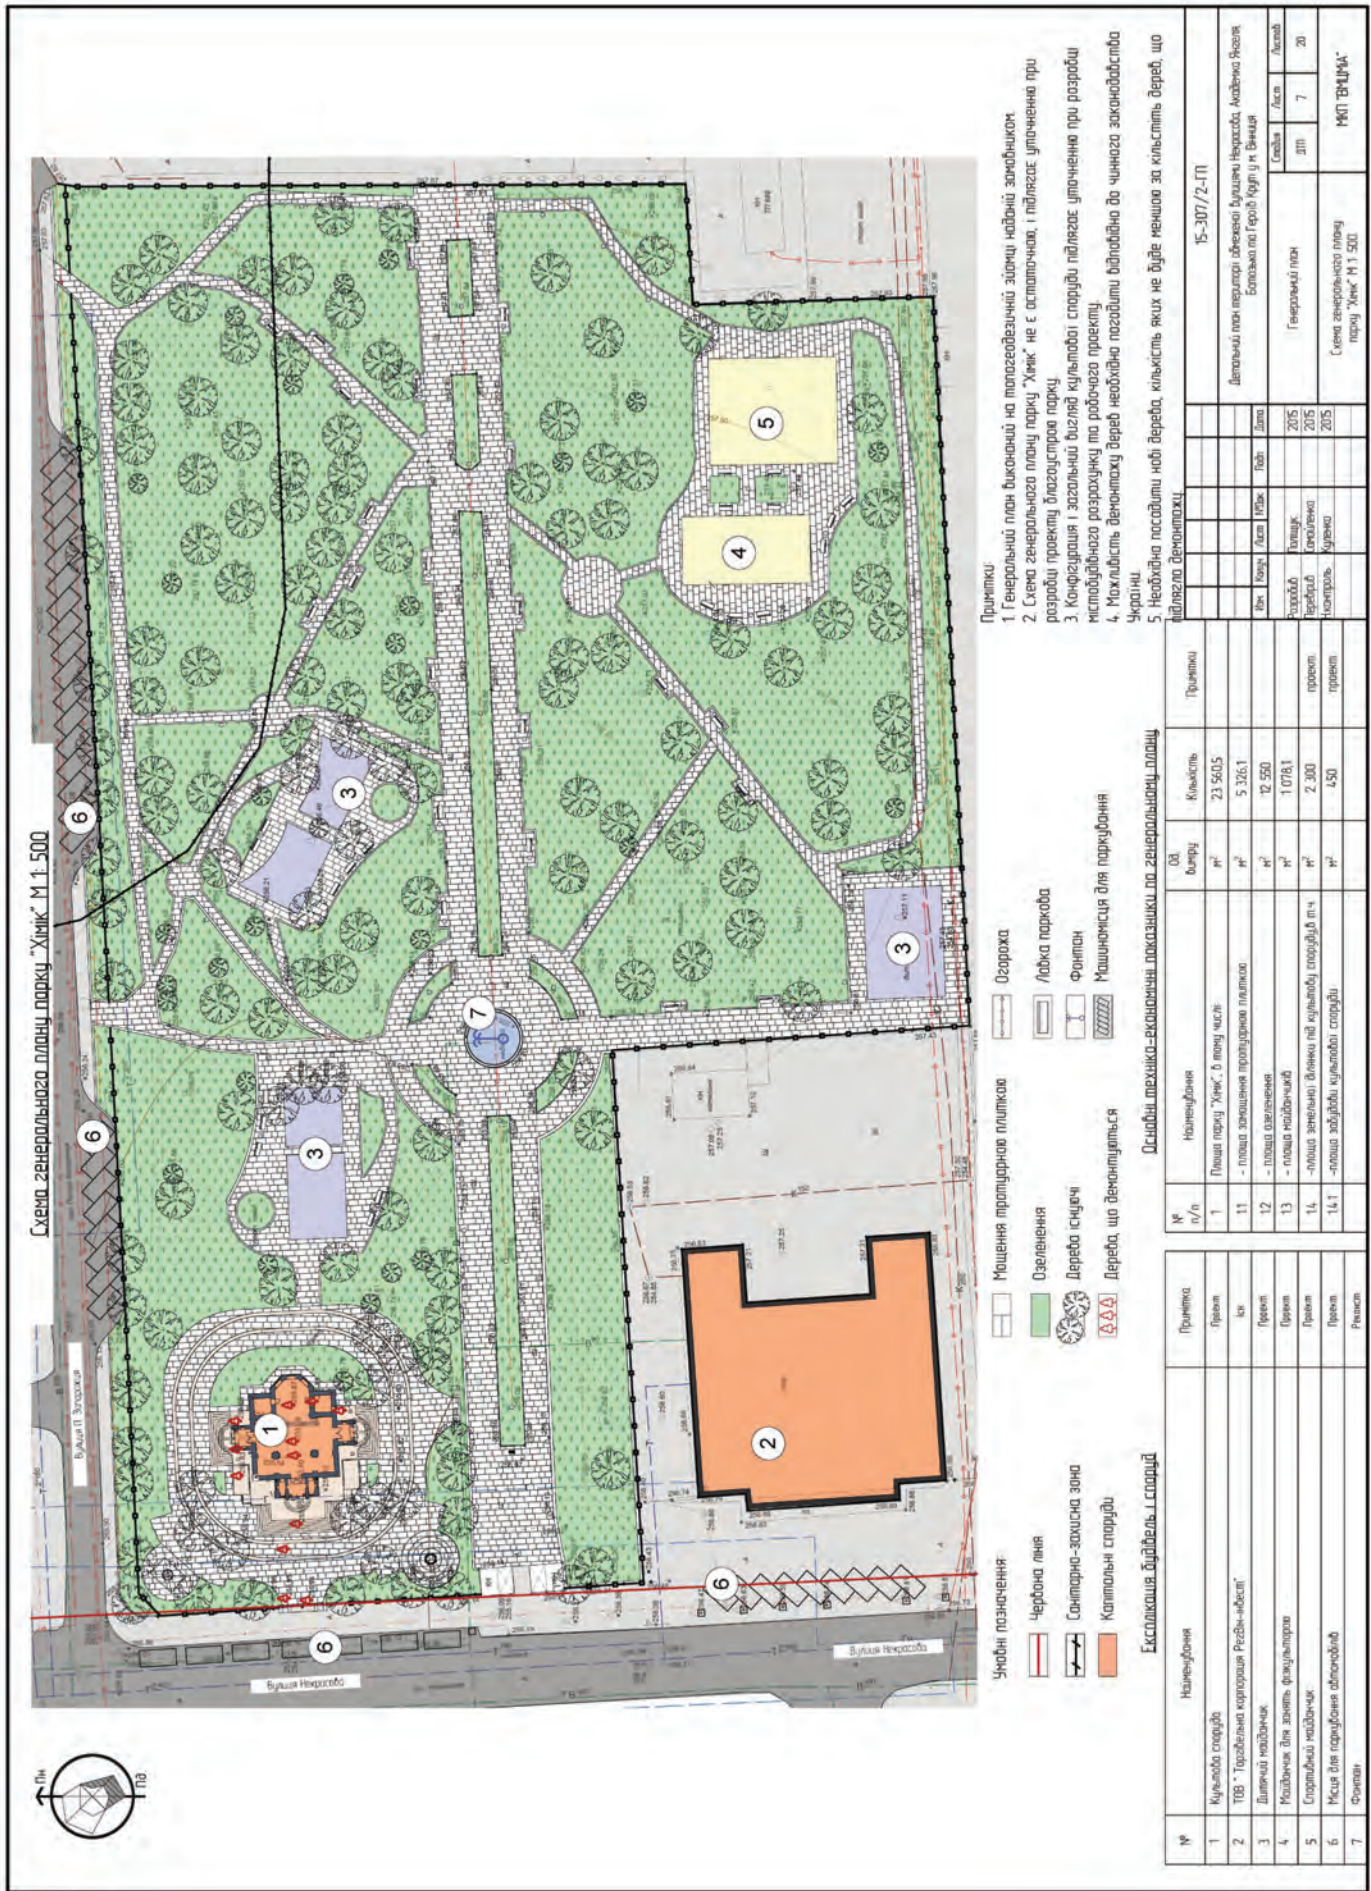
Схема Генерального плану парку «Хімік», м. Вінниця
